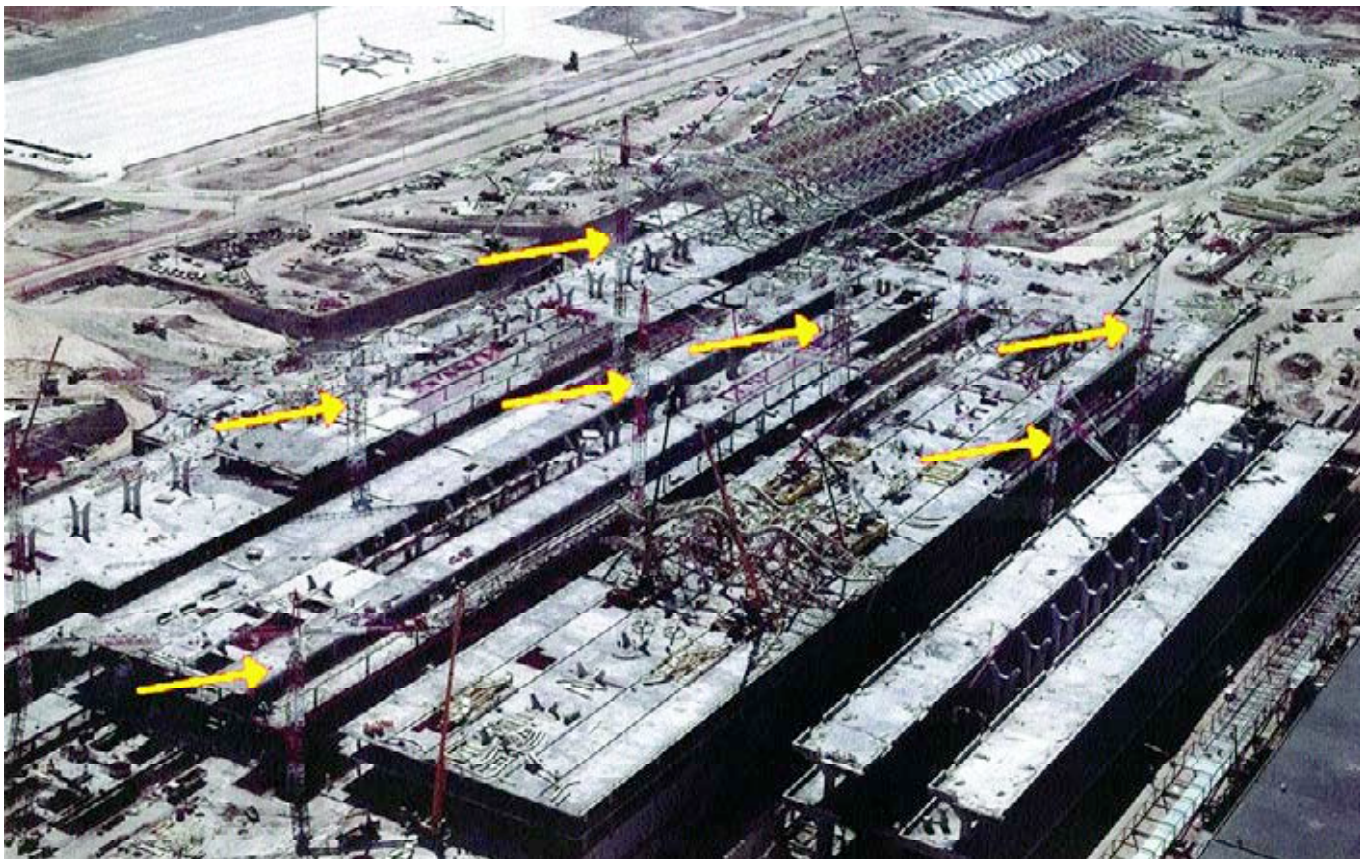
Montaje de estructura en obra: grúas torre previstas.
